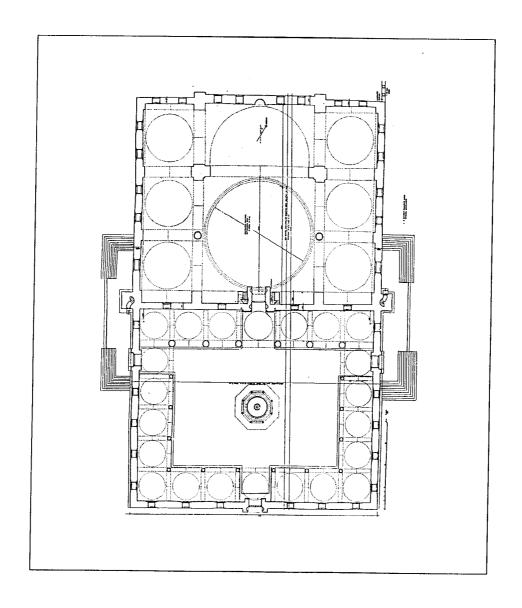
مسقط أفقي لمسجد إبراهيم Basgi في بورصه (أو بروسه) (عن : كوران) .
